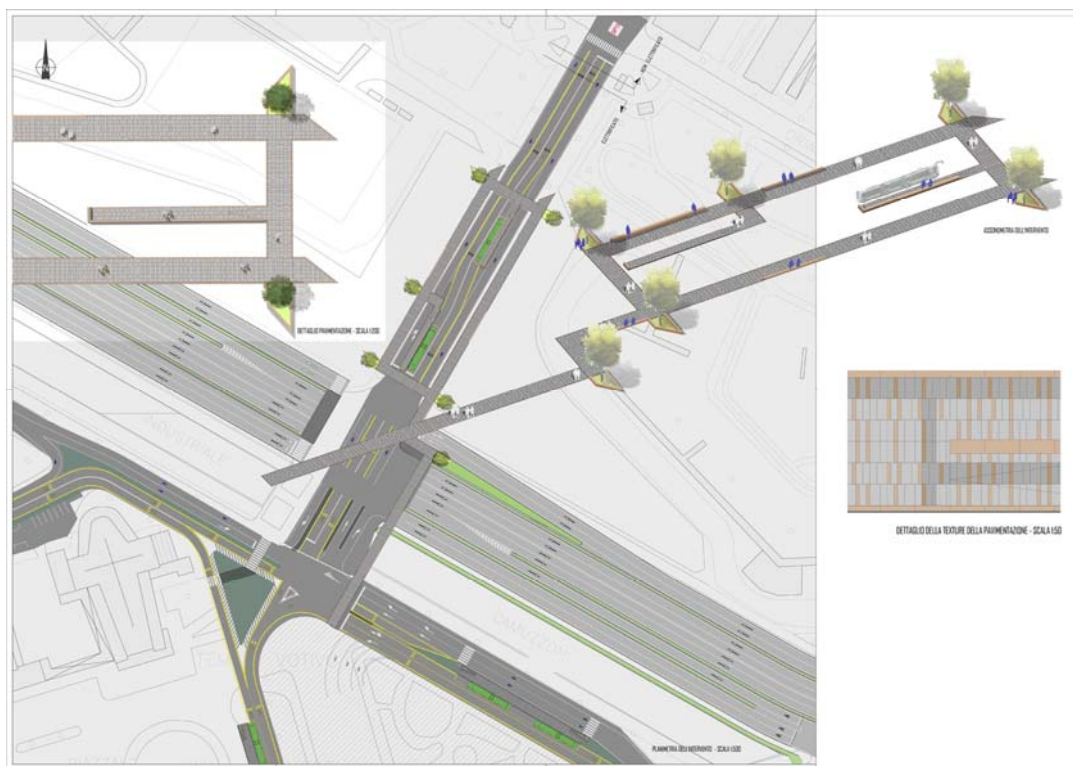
Planimetria di superficie del sottopasso Città di Nimes
